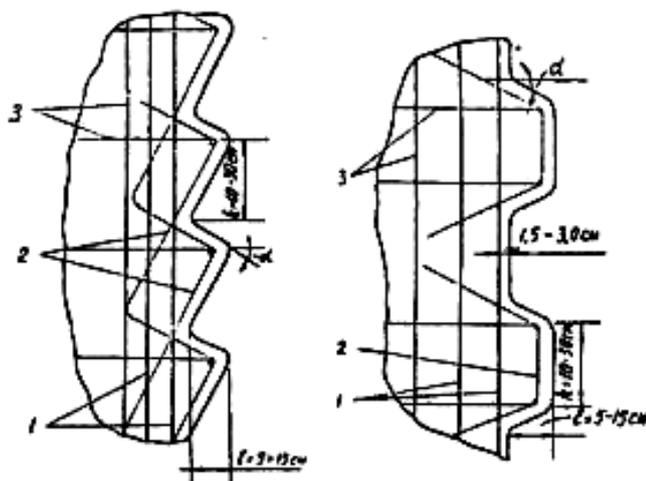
Конструкция зубчатых стыков и схема армирования выступов стенки: 1-сетки с ячейками не более 10×20 см; 2-арматура выступов; 3-хомуты и горизонтальные стержни ребра
